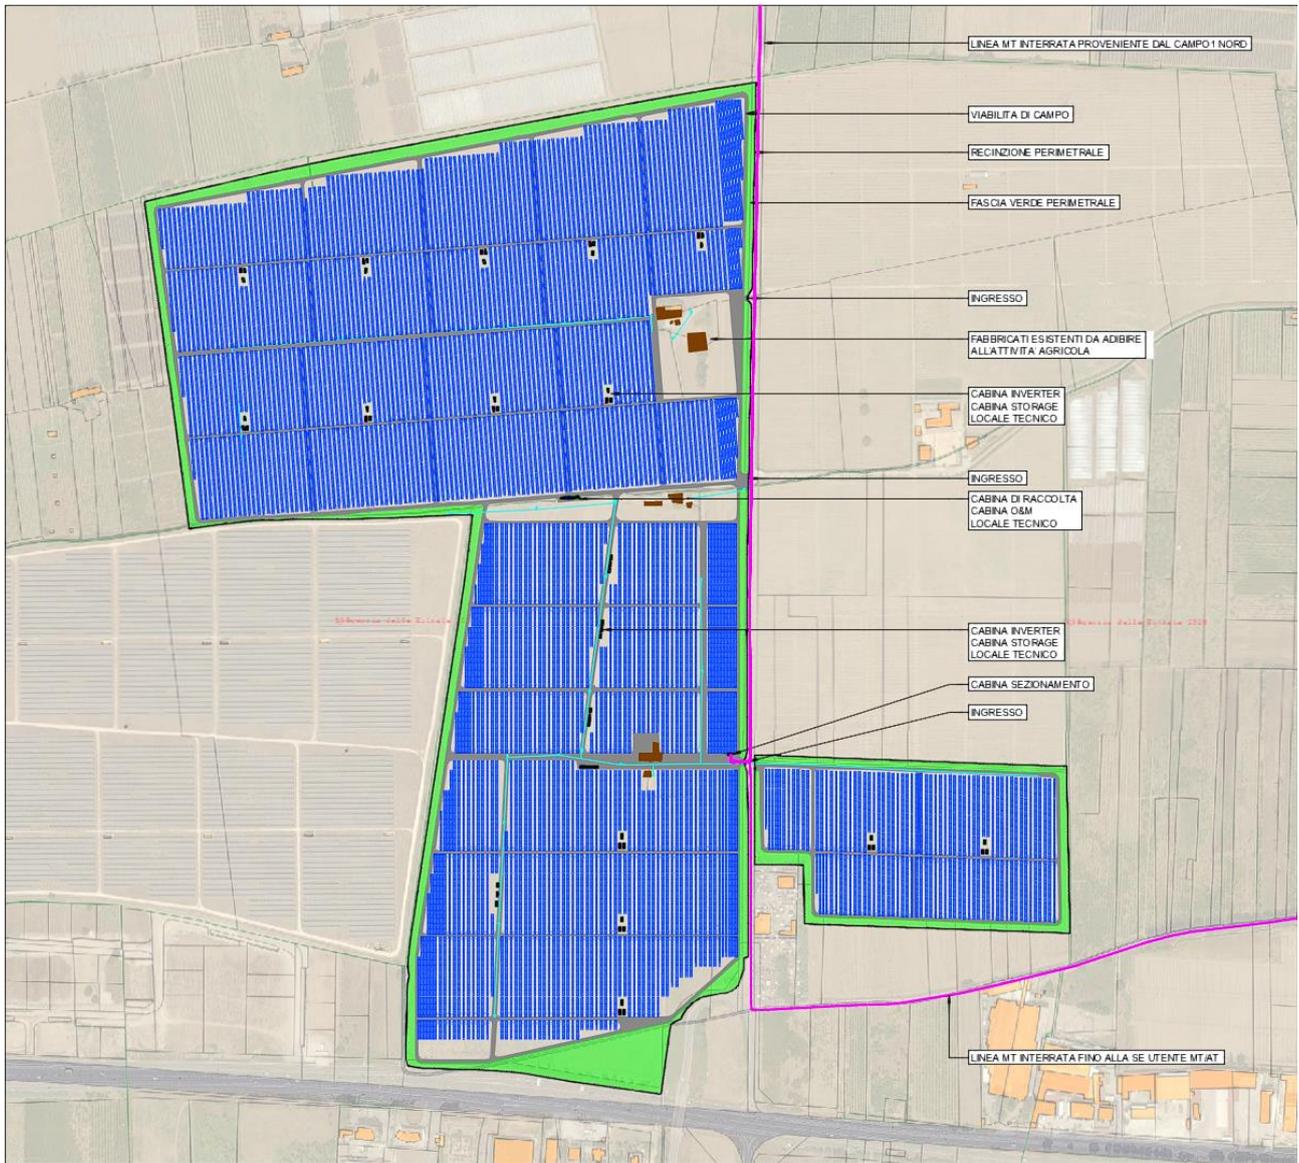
Rappresentazione del layout di impianto CAMPO2 sud
